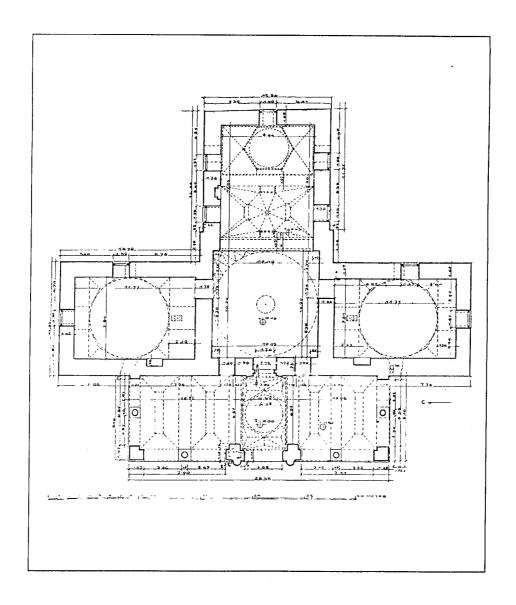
مسقط أفقي لعمارت غازي اورنوس بك في كوموتيني باليونان (عن : كيل).
